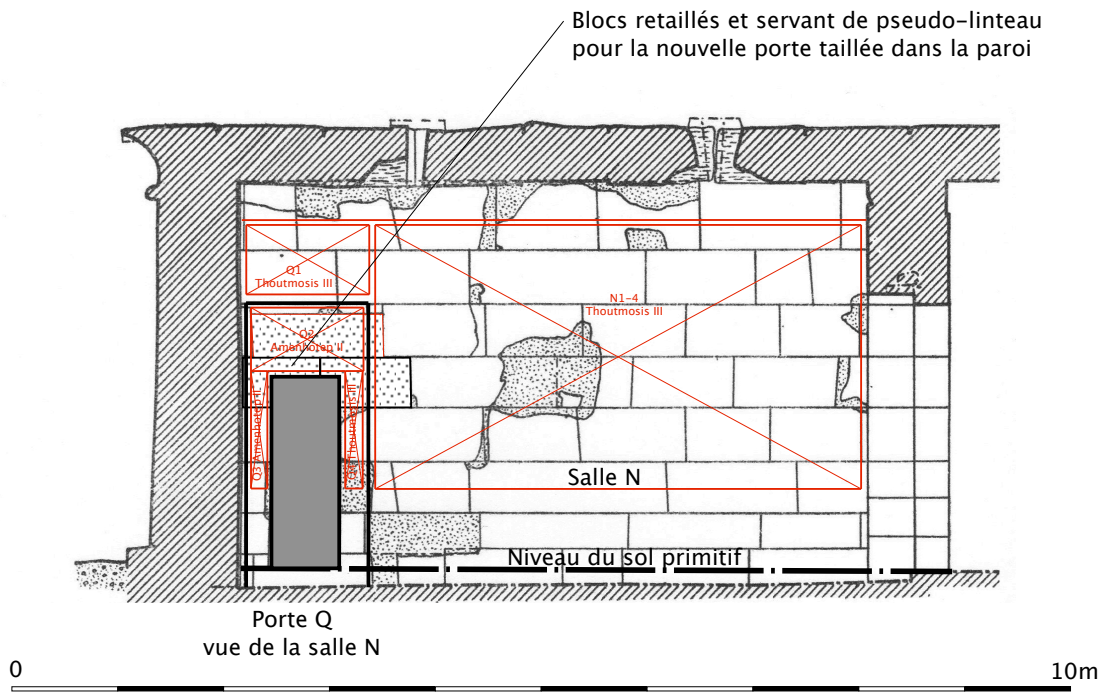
Coupe longitudinale sur la salle N, vue vers le sud (© J.-Fr. Carloti).
